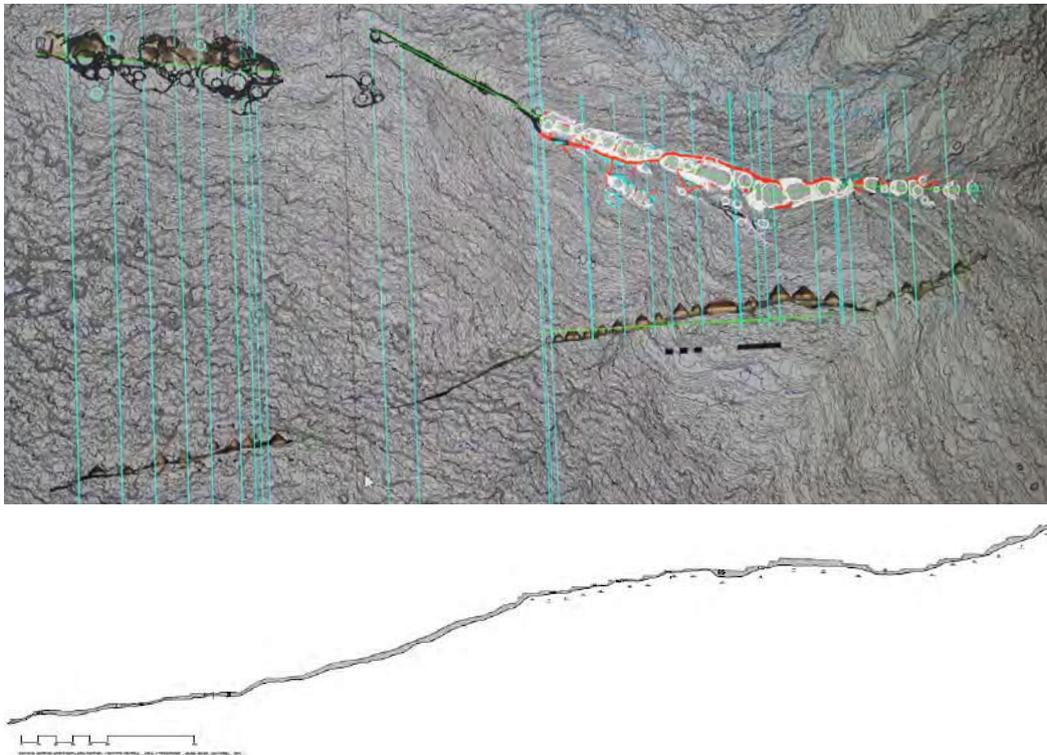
Dibujos en sección a partir de los modelos, en donde se puede ver la proyección a partir de la planta y de acuerdo con los niveles del terreno. Elaboración propia, 2023.
